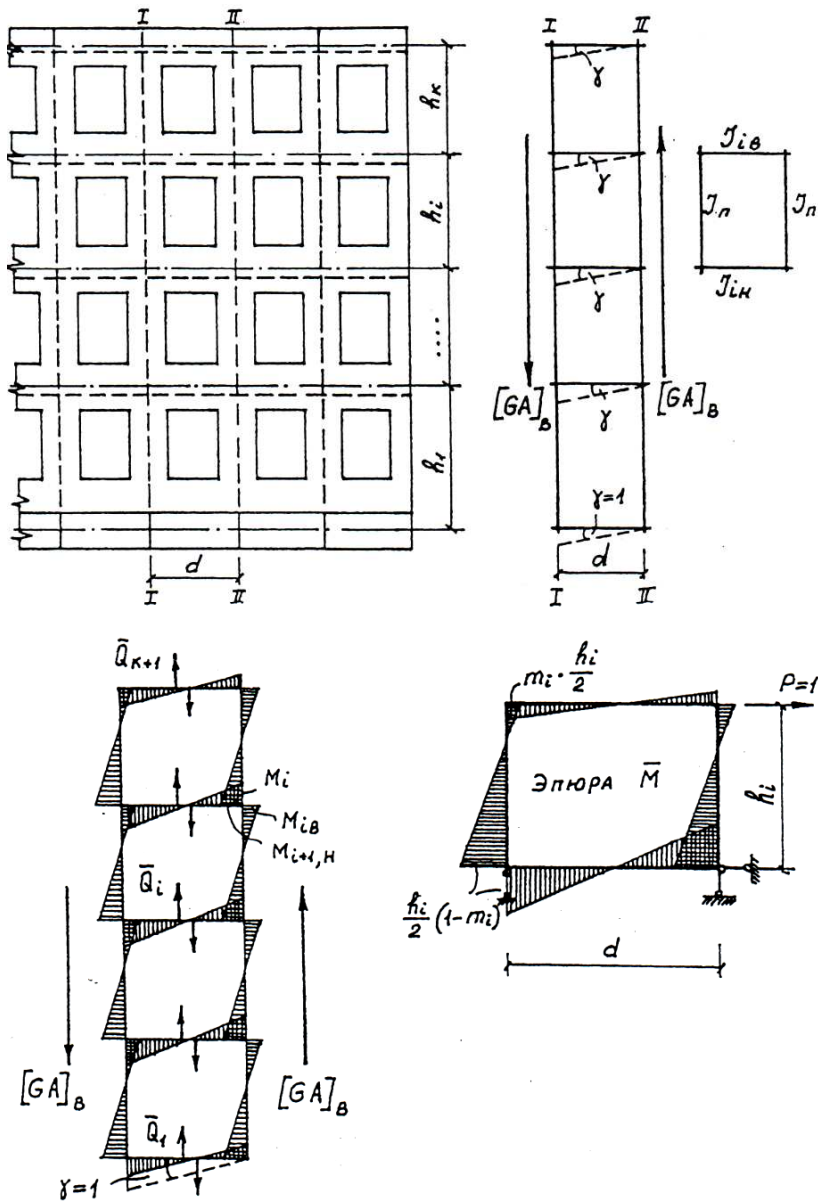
Схема к определению сдвиговой жесткости стены крупнопанельного здания по Б.А. Косицыну [12]
